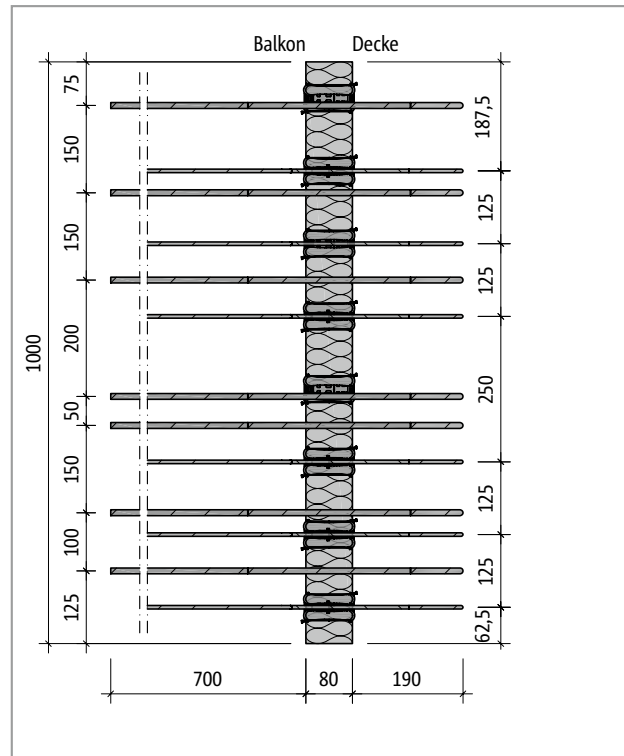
Schöck Isokorb® T Typ K-WU-M2: Produktgrundriss
